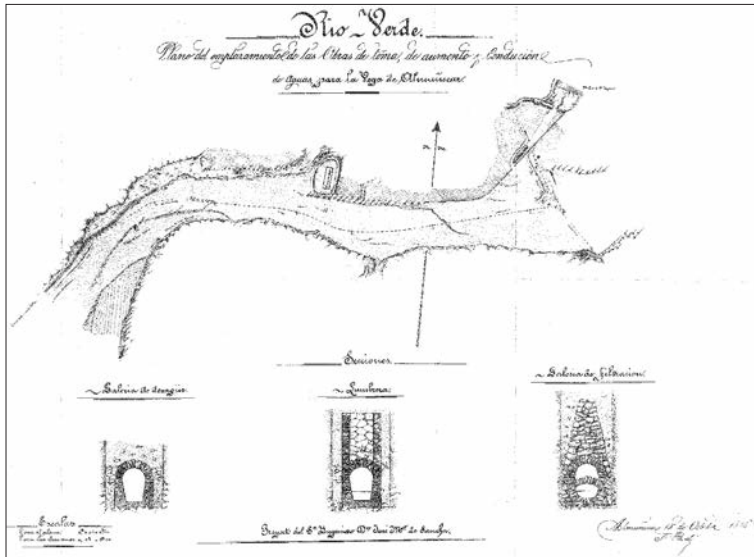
Plano de la galería de Las Angosturas, fechado en 1875 (dibujo: José María de Sancha).
